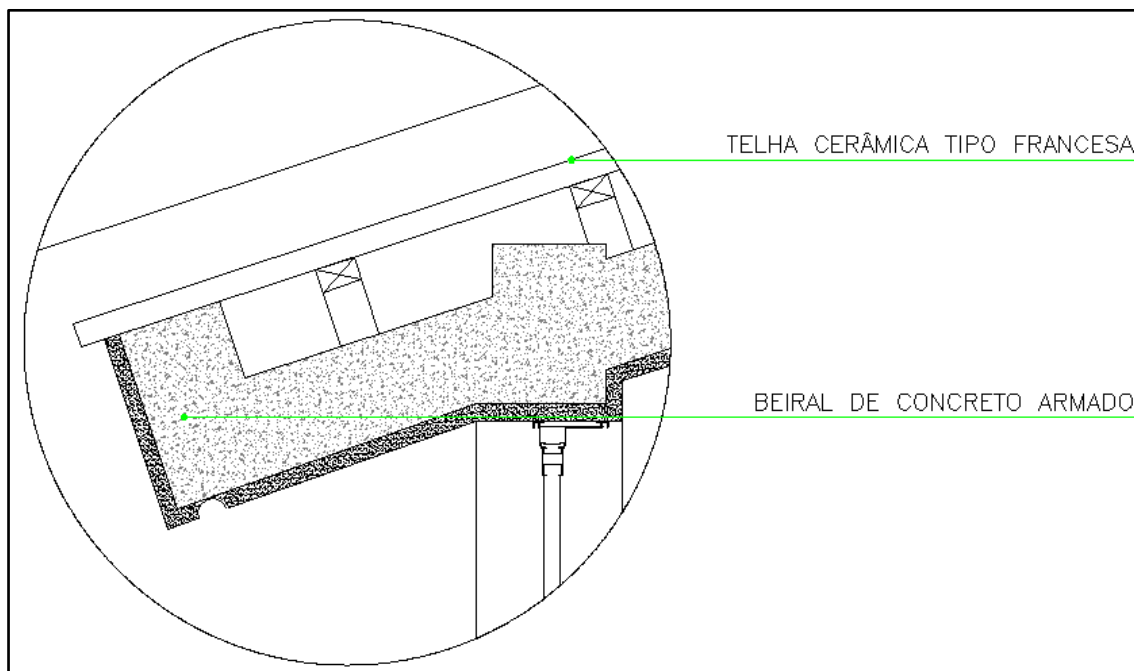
Detalhe genérico dos beirais em concreto. (Referência projeto da Larocca)
